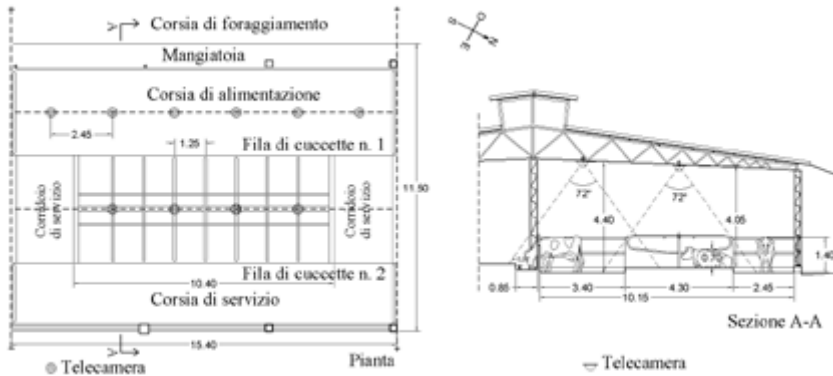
Pianta e sezione dell'area della stalla utilizzata per la prova.
